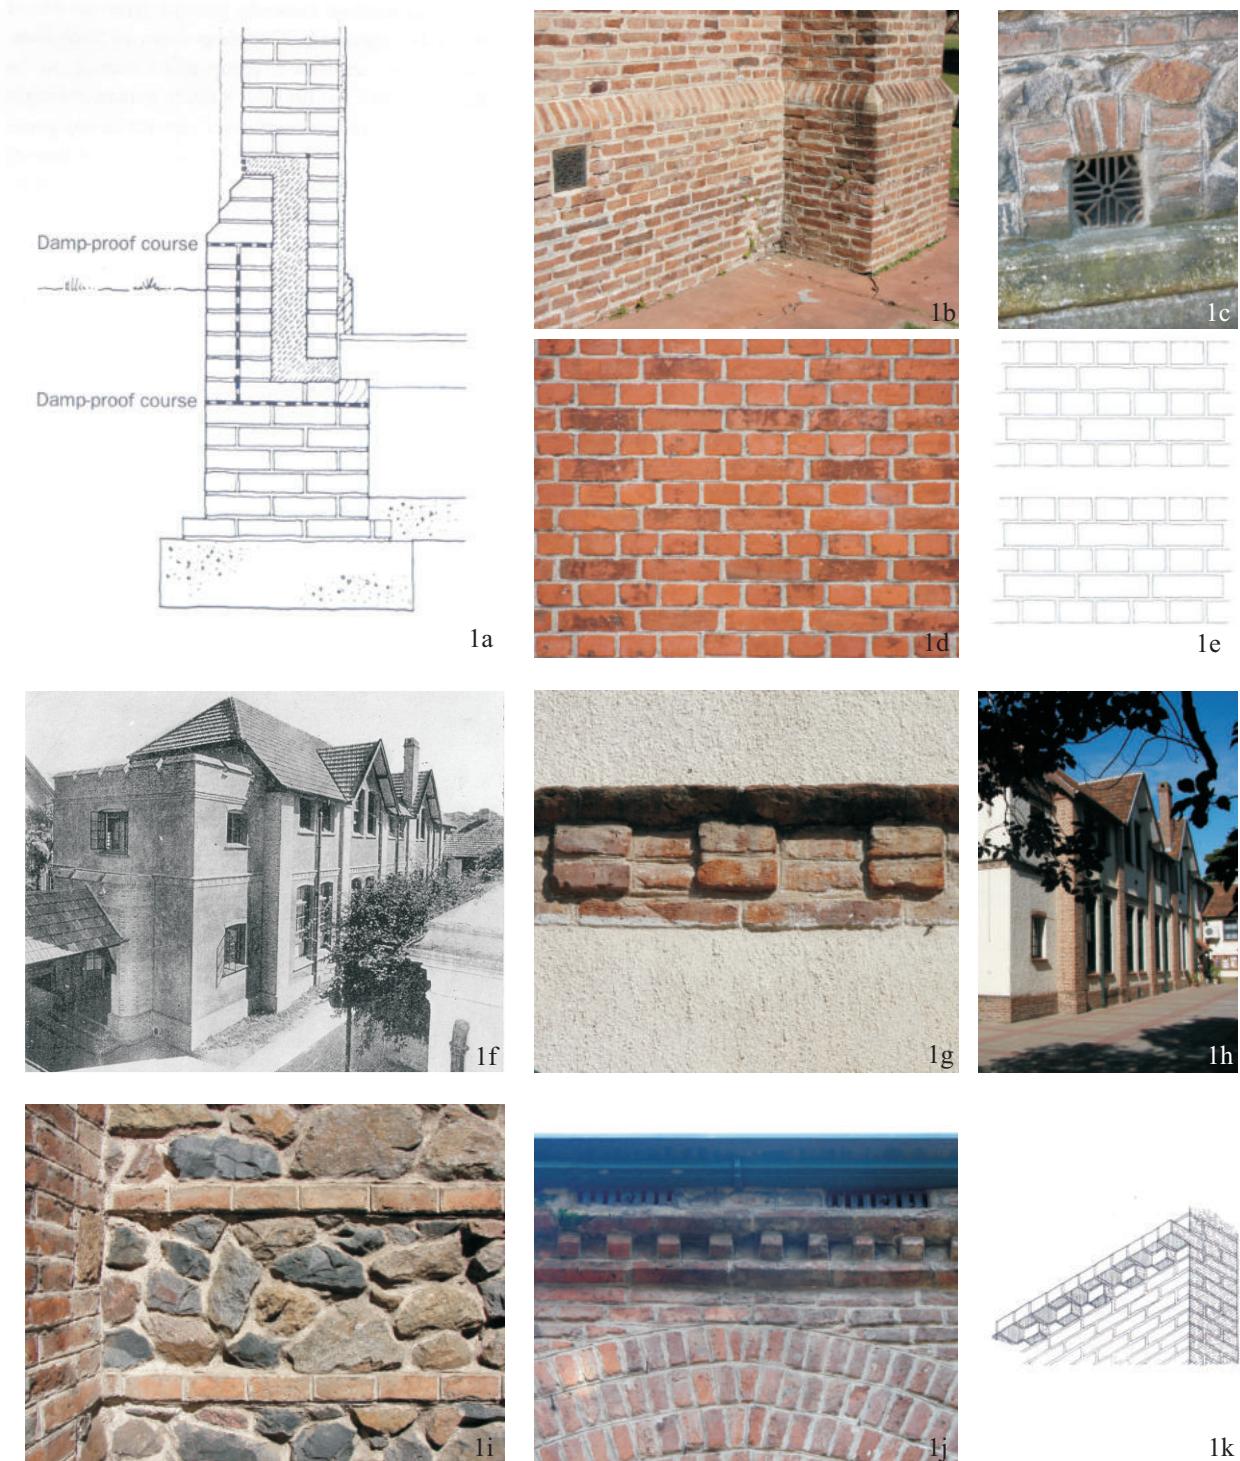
detalle de muro portante con ensanche en zócalo y rejilla de ventilación según Johnson (2006:52, Fig.44). Fig.Nº1b: detalle de muro de ladrillo a la vista con ensanche en zócalo, capilla del Colegio San Jorge; Fig.Nº1c: ventilación de cámara en Iglesia Anglicana. Fig.Nº1d: aparejo inglés, Iglesia Presbiteriana. Fig.Nº1e: traba holandesa, traba inglesa, tipos de aparejo según Johnson (2006:48, Fig.37 y Fig.38); Fig.Nº1f: guarda dentada perimetral a nivel del primer piso, Assembly Hall, Colegio San Jorge; Fig.Nº1g: guarda dentada, Assembly Hall. Fig.Nº1h: vista actual del Assembly Hall. Fig.Nº1i: detalle de muro de piedra alternado con hiladas de ladrillo a la vista, Iglesia Anglicana. Fig.Nº1j: cornisa dentada y ventilaciones bajo cubierta, Iglesia Anglicana. Fig.Nº1k: cornisa dentada difundida en Inglaterra en el período entre guerras, Johnson (2006:51, Fig.43).
